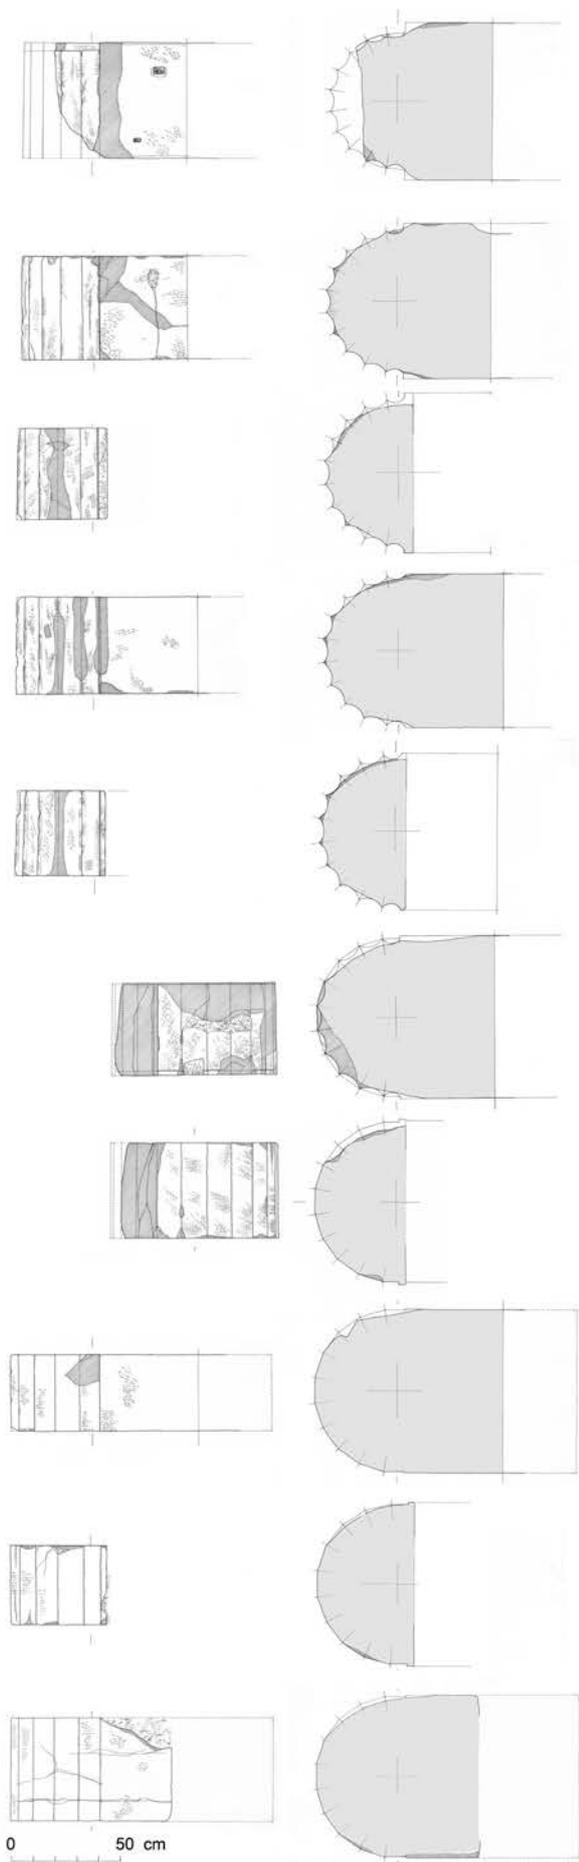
Navata centrale, semicolonna NS 1, prospetto laterale e sezione orizzontale dei roccchi eccetto il IV e V che presentano un prospetto frontale.
